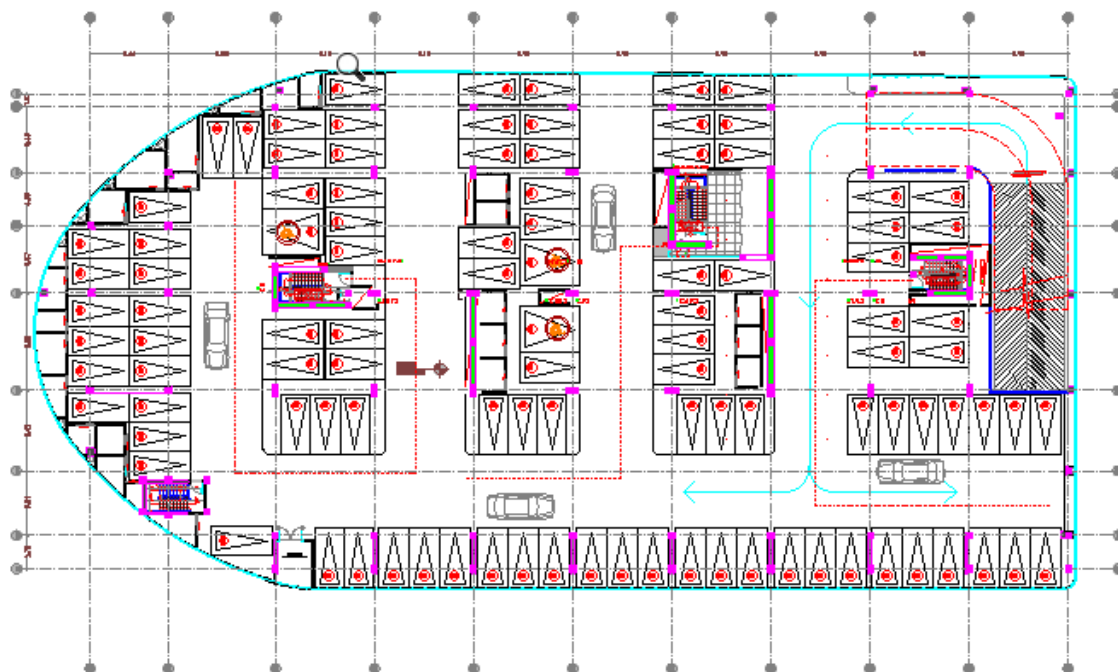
Planta de aparcamiento piso dos, columnas (lila) y arriostramientos (verde).
